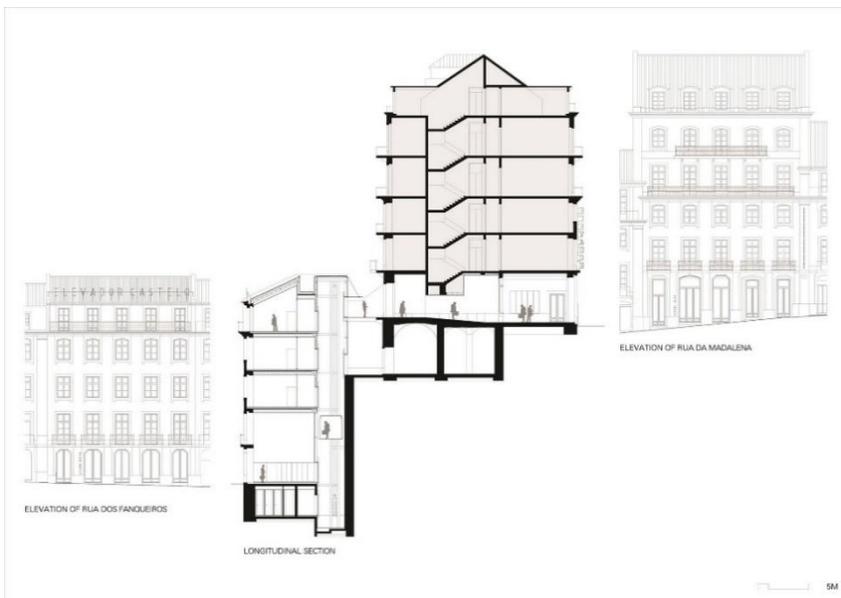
Desenhos dos alçados e corte do projeto Elevador do Castelo.
